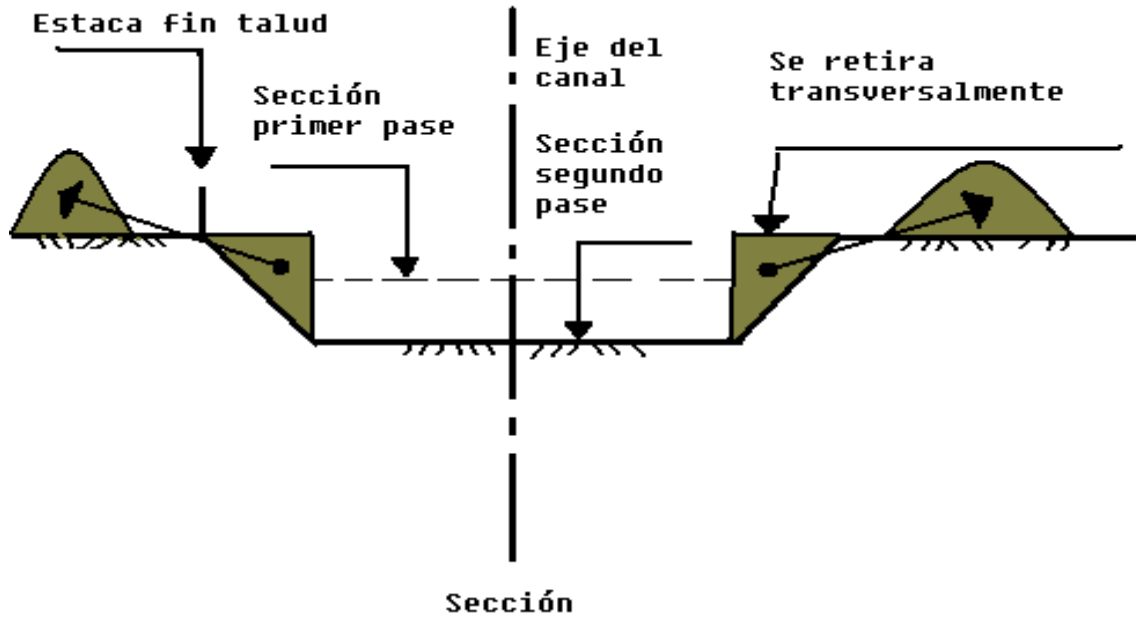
Apertura o excavación de canales de sección trapezoidal.
